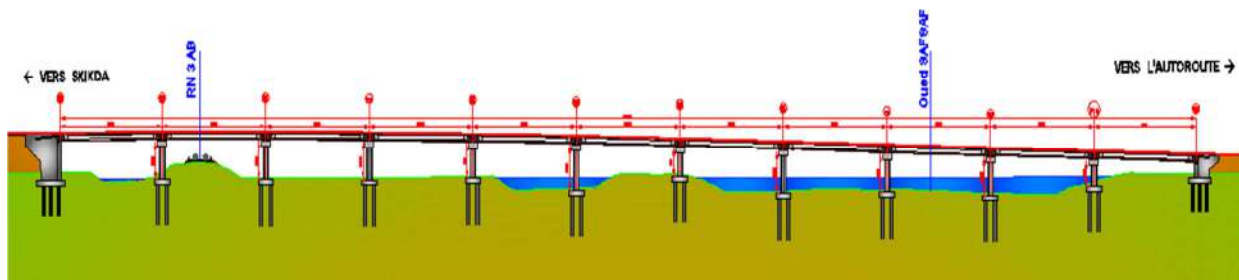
profil en long de la variante pont à poutre précontrainte
